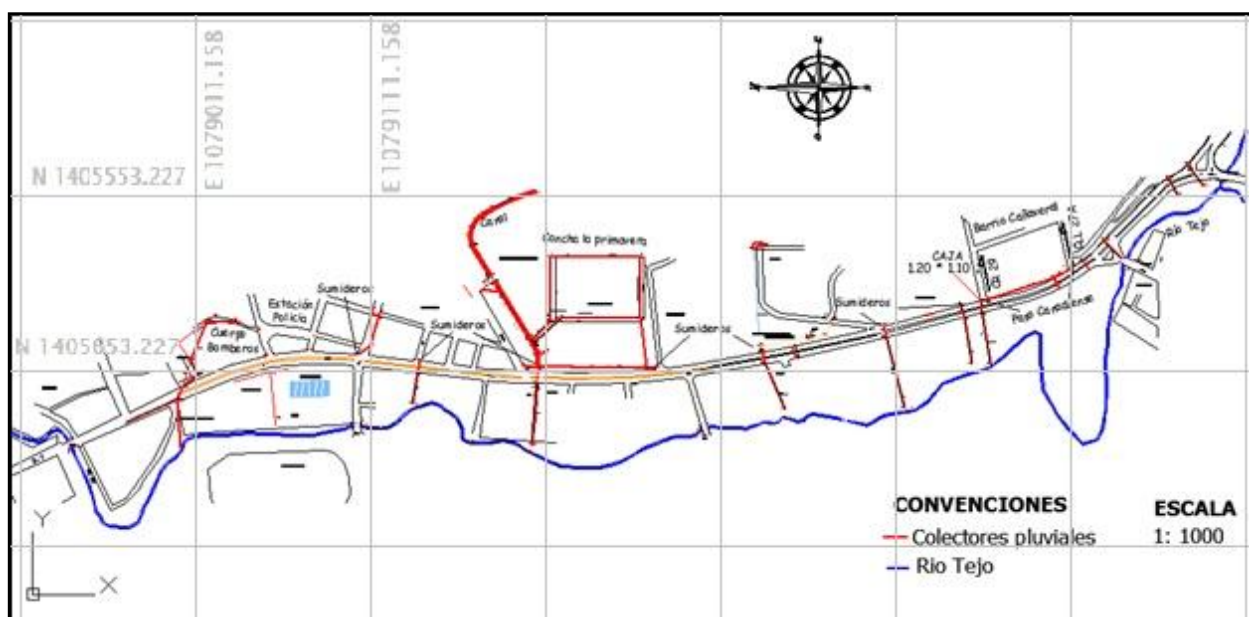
Plano en planta con la localización del sistema pluvial existente. Fuente: Autores del Proyecto.
